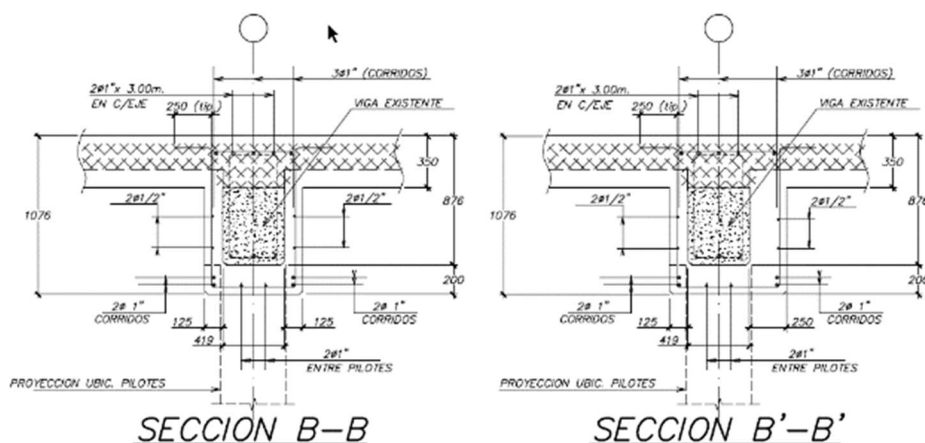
Refuerzo de vigas - Sección típica de vigas longitudinales
